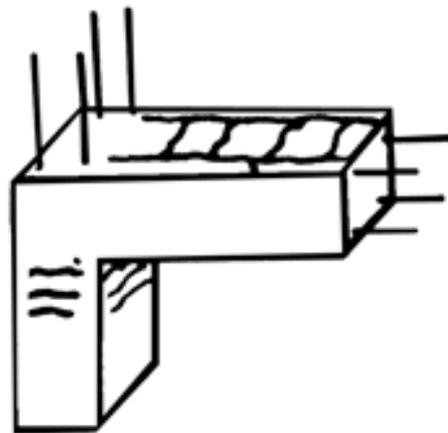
Fisuras por retracción hidráulica en una viga.
